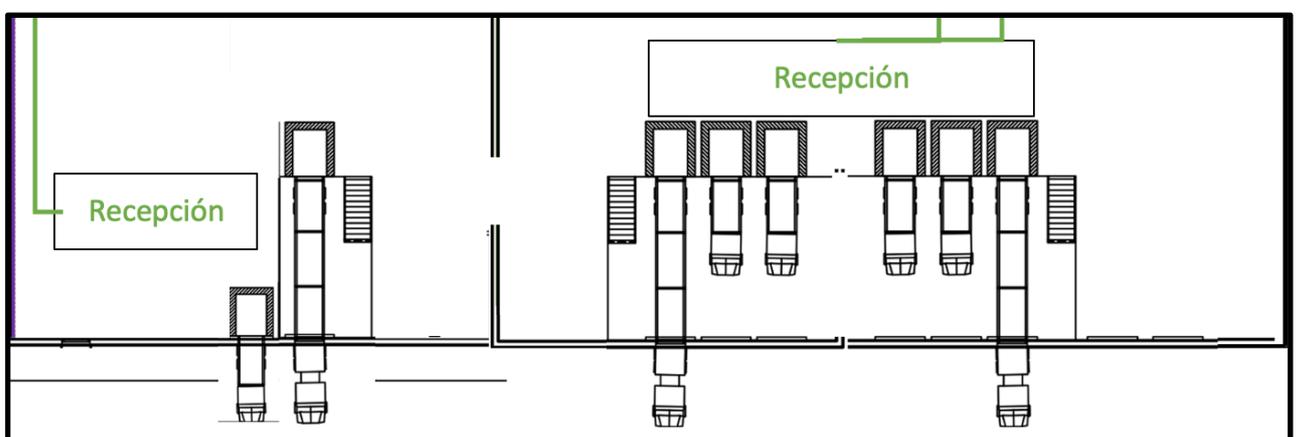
Zona de recepción planta sótano. Fuente: Elaboración propia.
